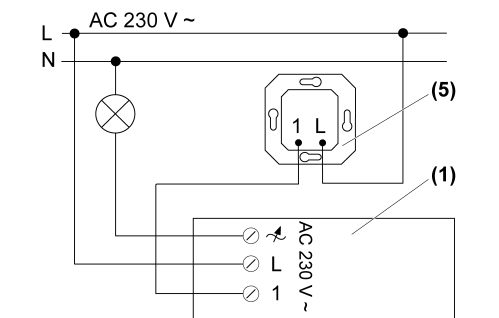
Anschlussplan Dimmer mit Nebenstelle 2-Draht
